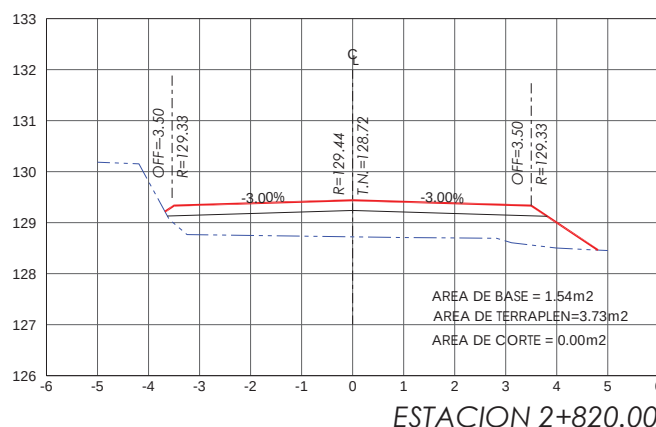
Corte Transversal de una sección tipo en terraplén
